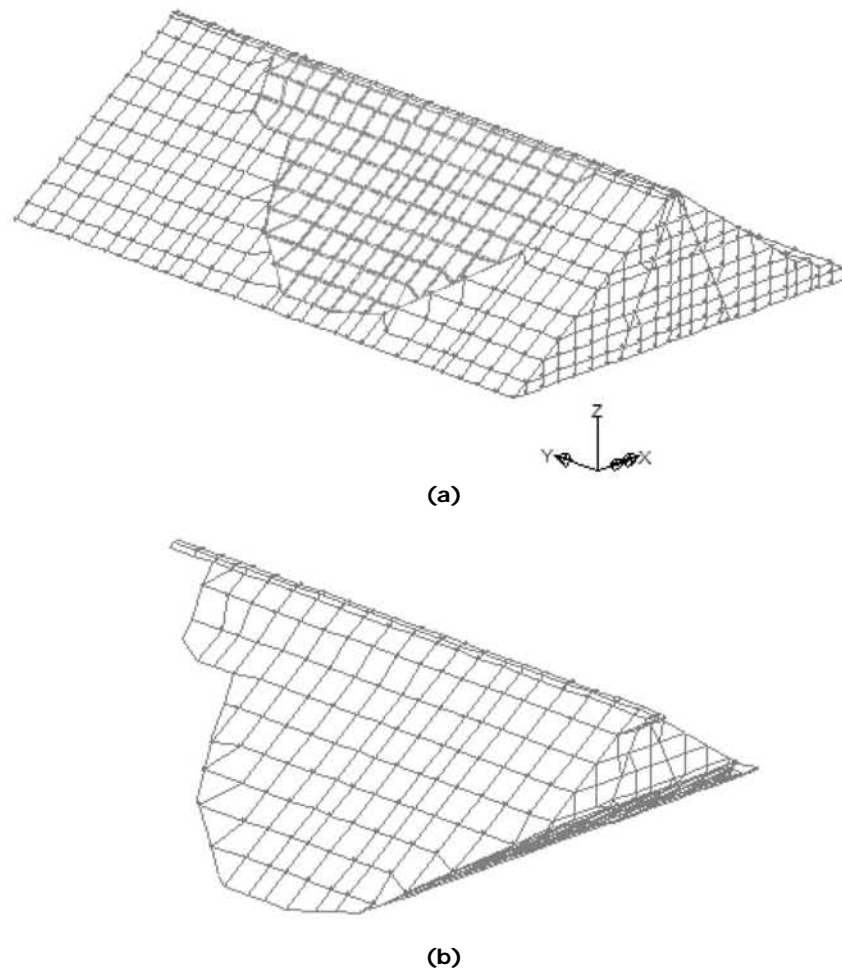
Vistas tridimensionales del modelo: (a) la cortina y su cimentación, (b) la cortina.
